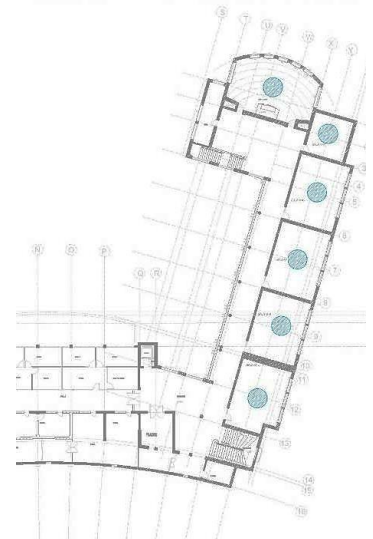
, 172 y 173. Esquema Planta Zona Propuesta, Creación Propia.
